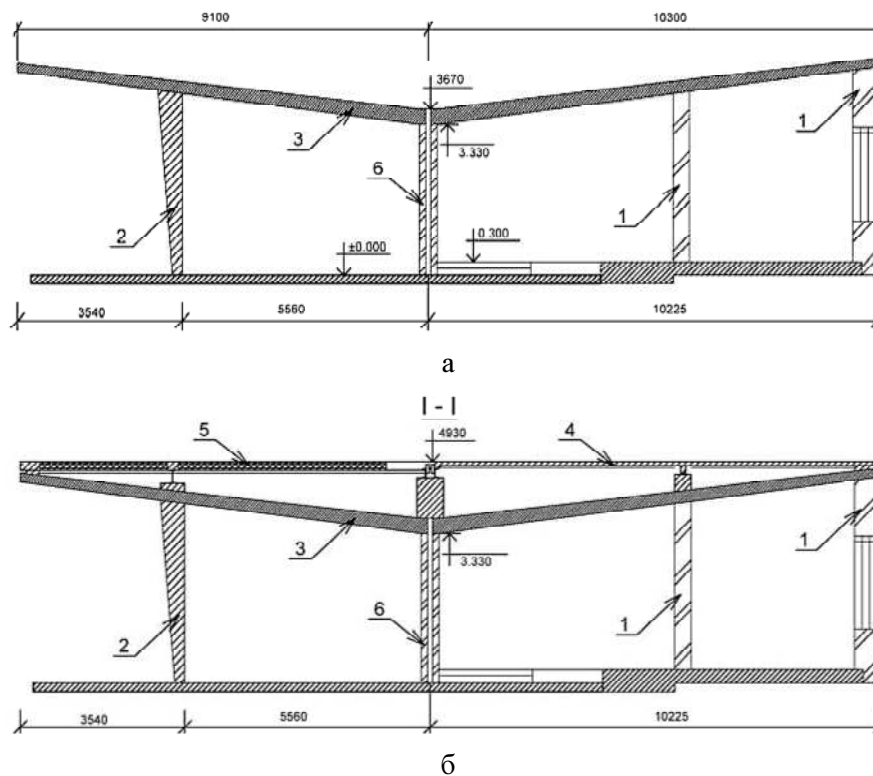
Поперечний переріз будівлі до (а) і після (б) реконструкції:
